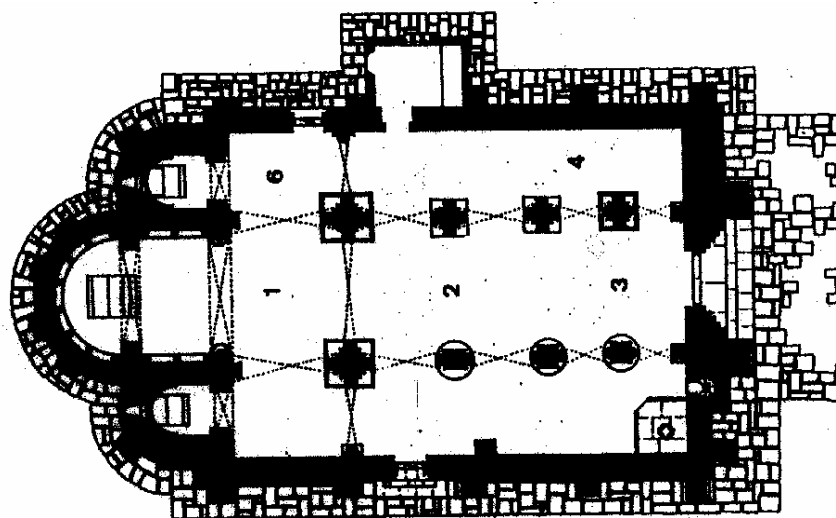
Planta da igreja de São Pedro de Rates [3]
